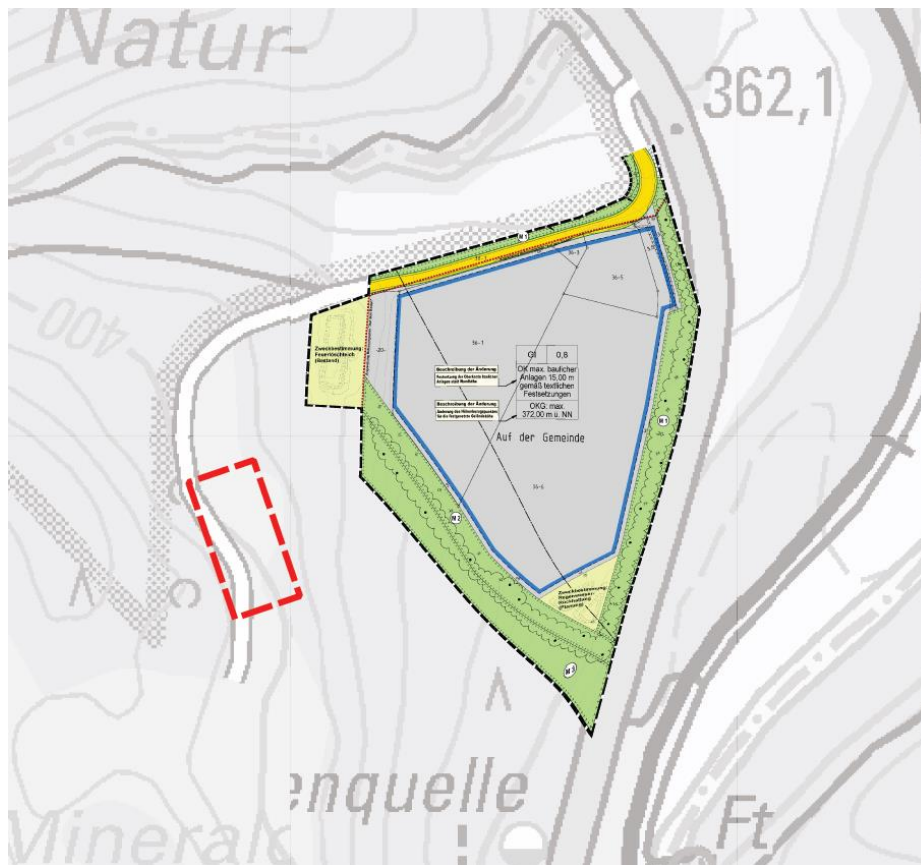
Geltungsbereich der vorliegenden Planung mit angrenzendem Bebauungsplan "Auf dem Boden"
